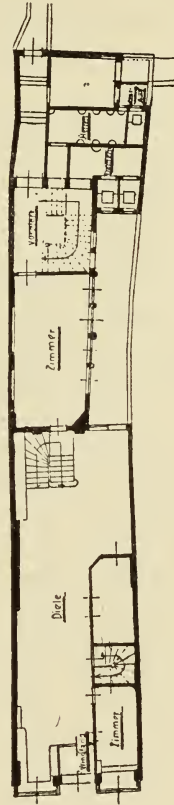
Haus Langenstrasse 12 in Bremen. Grundriss. (Aus «Bremen u. seine Bauten», hrsg. vom Architekten- u. Ingenieur-Verein. (Zu S. 83.)
